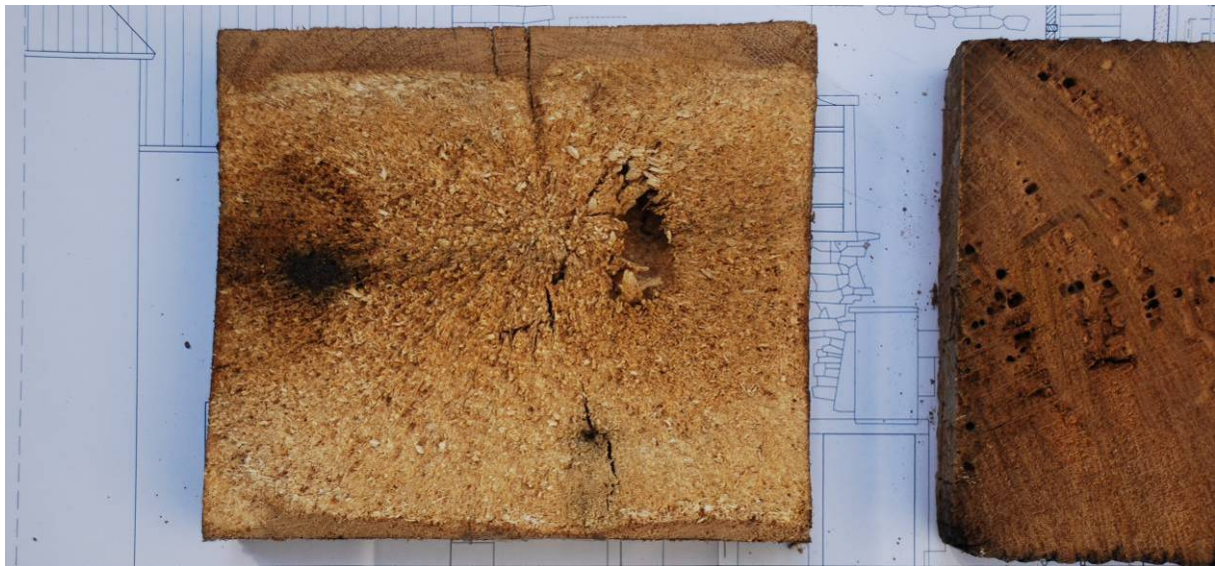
Von Hausporling befallener Eichenbalken (ca. 18 x 22 cm). Während die Oberflächen äußerlich intakt wirken, ist das Holz im Inneren bereits völlig zerstört, einhergehend mit einem enormen Gewichts- und Stabilitätsverlust.
